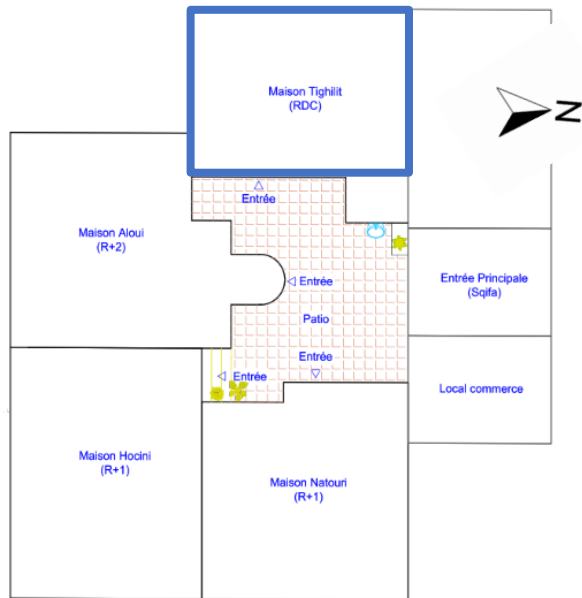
Plan des maisons autour du patio, la maison Tighilit encadrée en bleu
